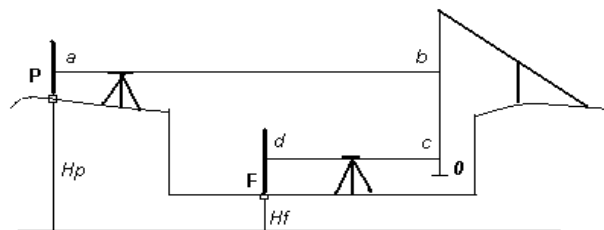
Схема перенесення проектних відміток на дно котловану і на висоту
